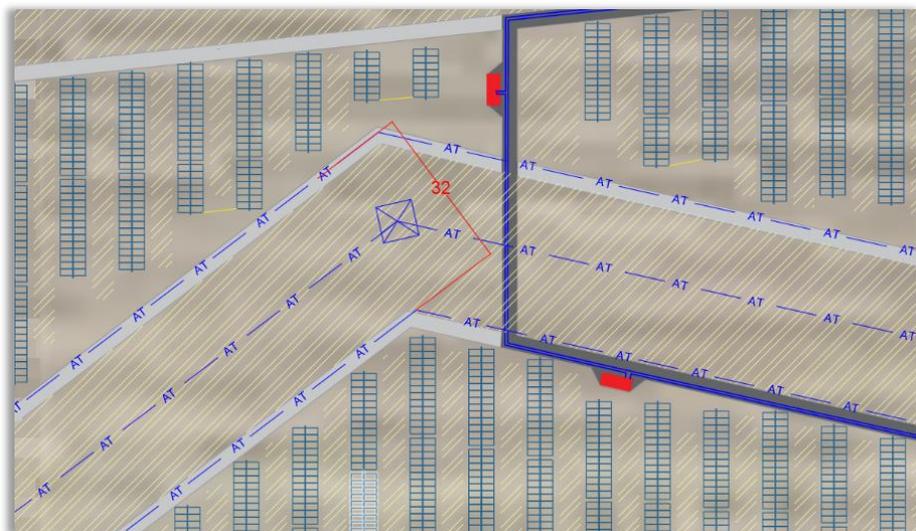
Layout Impianto con indicazione fasce di rispetto elettrodotto AT
